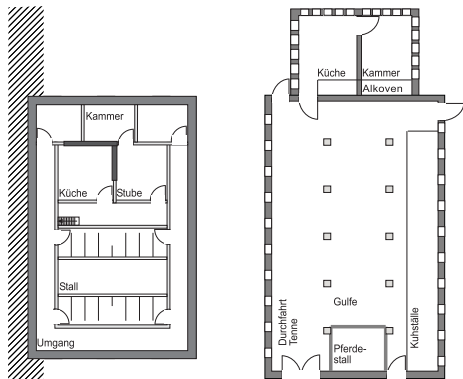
Grundrisse der Musterhäuser des Umgangshauses (links) und Gulphauses (rechts).
